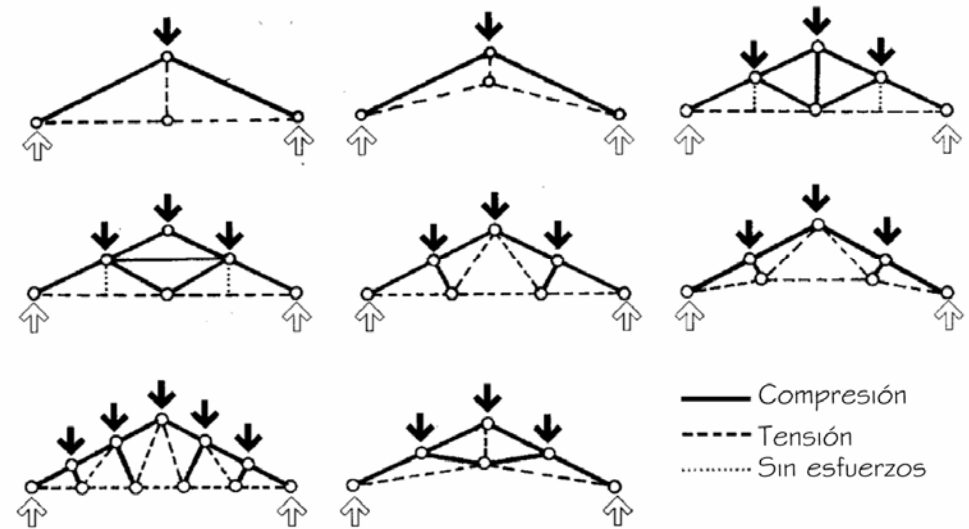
Esfuerzos en armaduras inclinadas.
